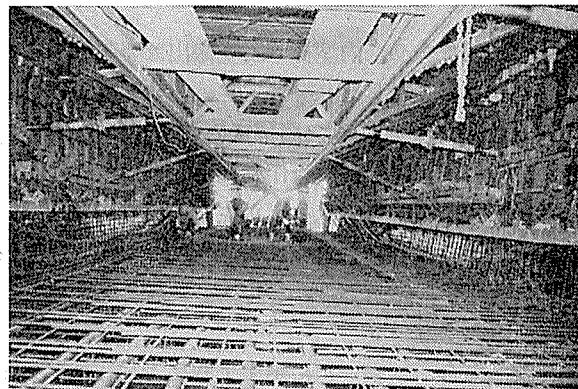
下床版配筋作業（ゲリュースト ワーゲン）
